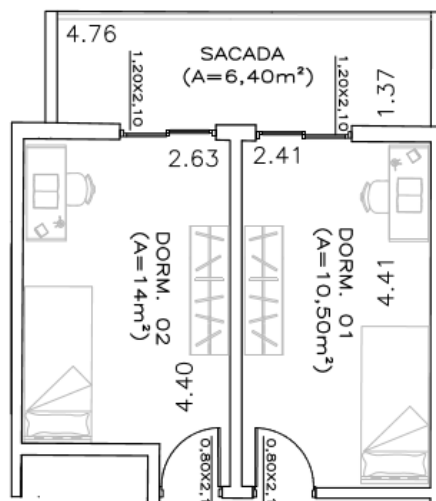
| Detalhe Planta de Estudos mais acessos- Fonte: Acervo do autor, 2016
